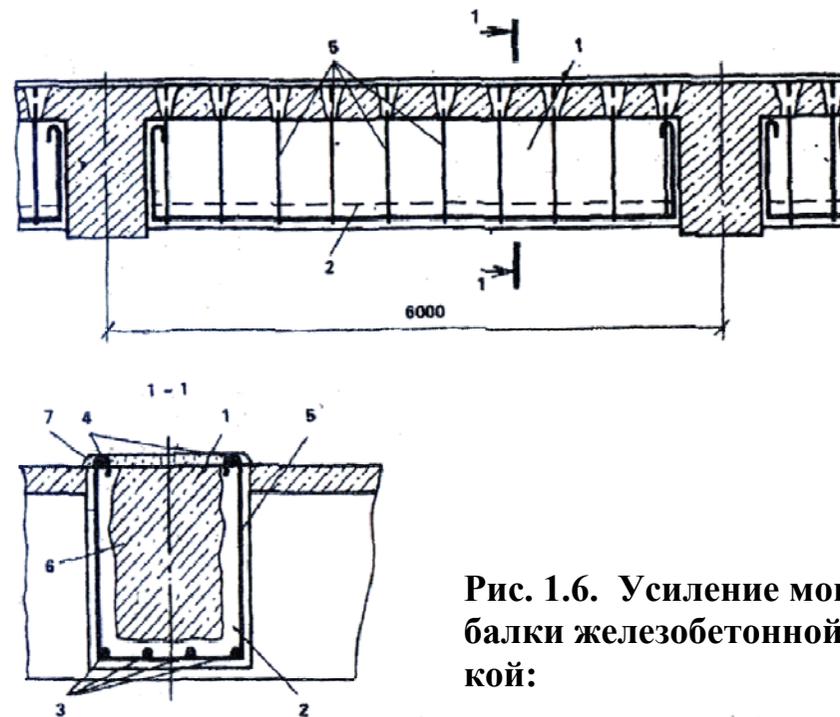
Усиление монолитной балки железобетонной рубашкой:
